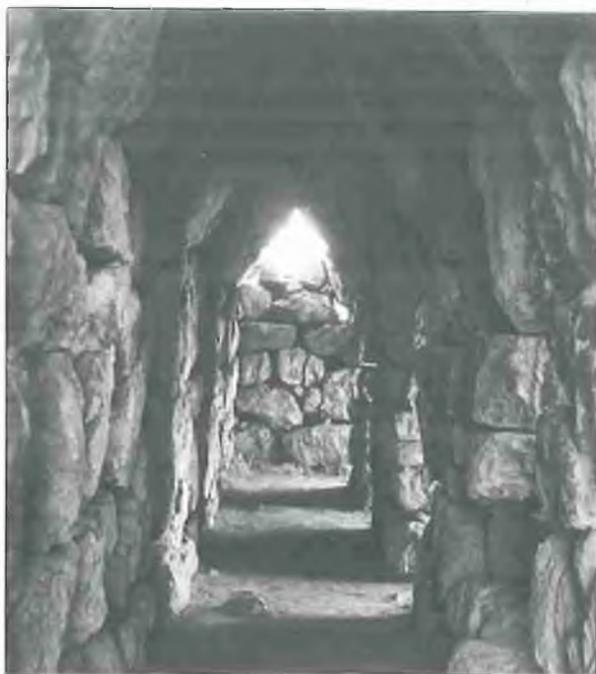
Galería cubierta con falsa bóveda en el interior de las murallas de la ciudad de Tirinto.
